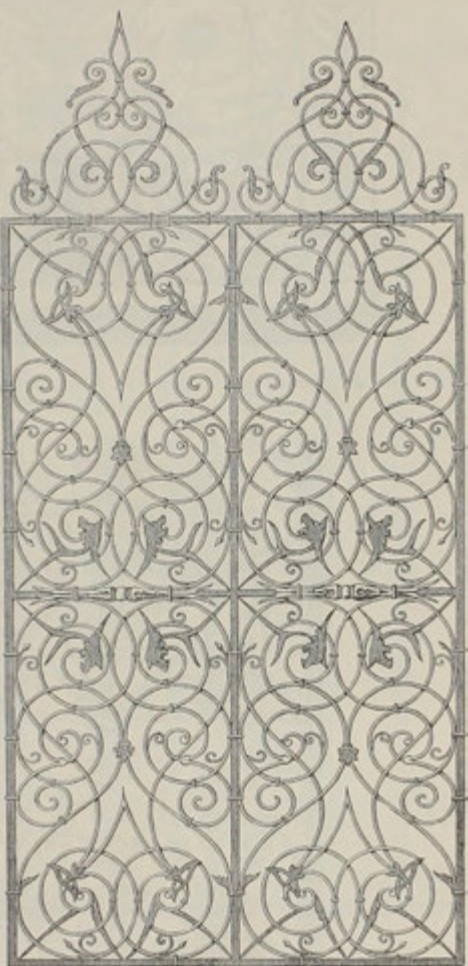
Mříž z kovaného železa ve starém zámku Stuttgartsém (ze stol. 16.).
